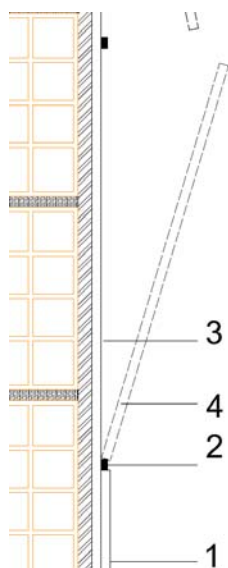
Destacamento do Cerâmico Colado. Figura 20 - Fissuração das Juntas do Cerâmico.
